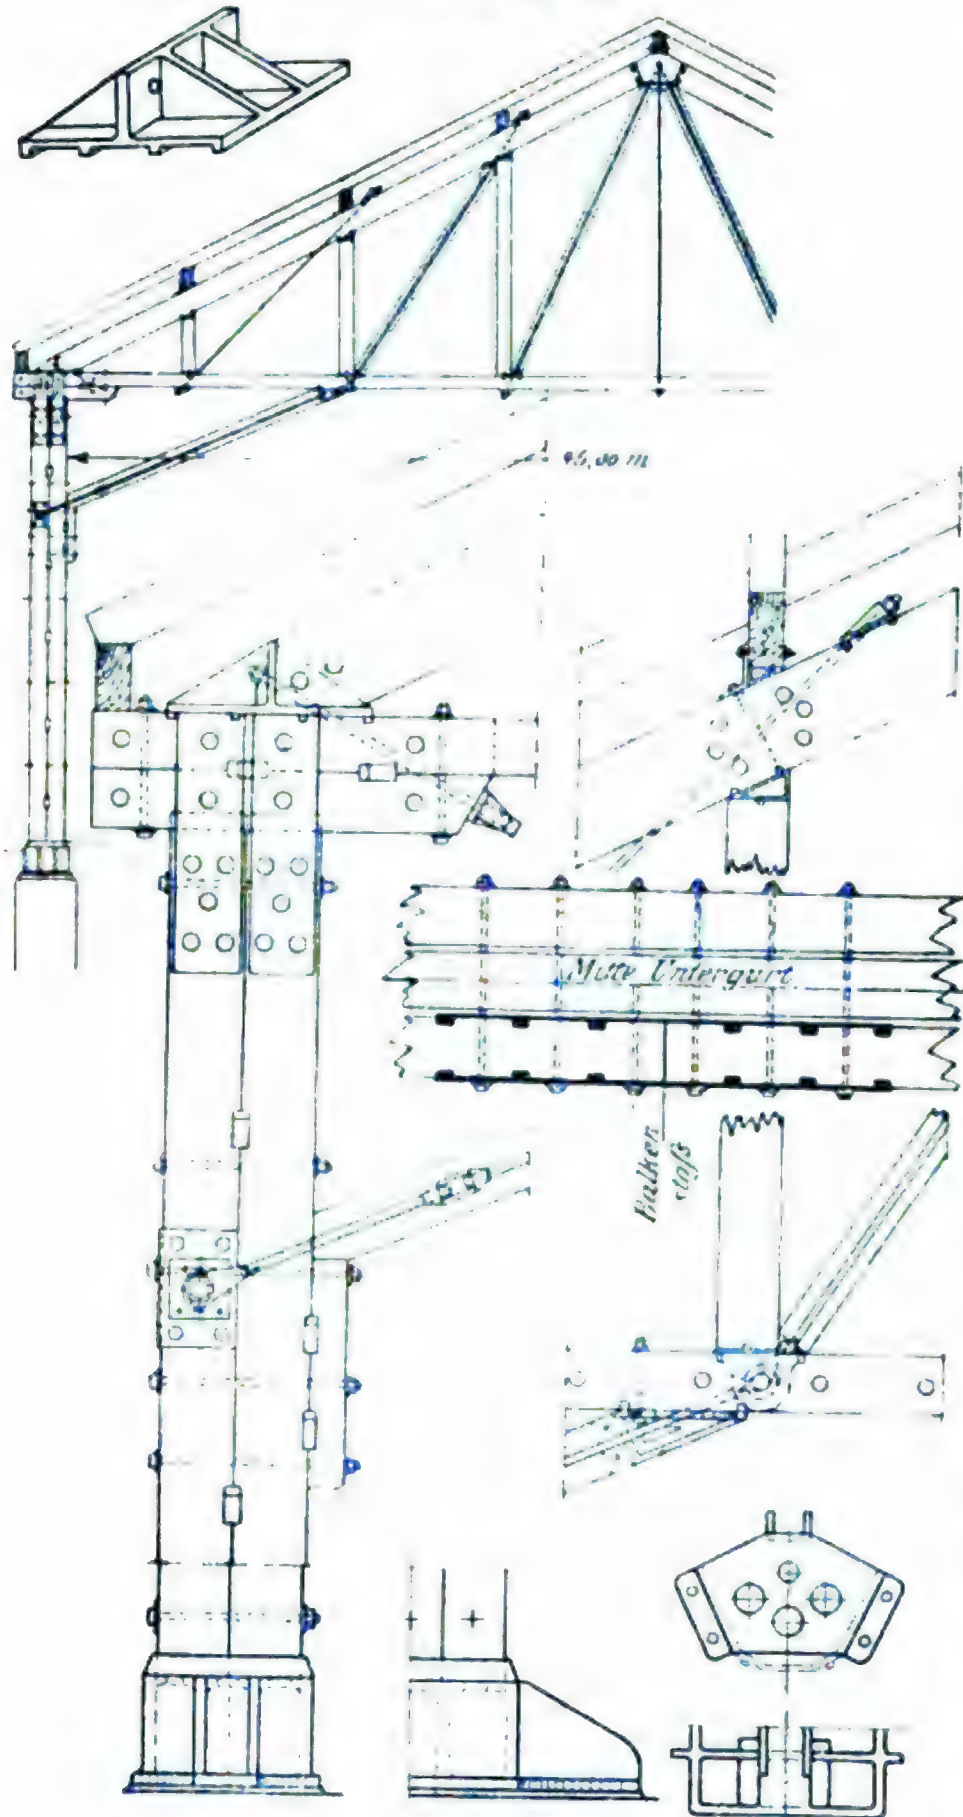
u. 89. Hohes Dach für Kirchen- und Saalbauten. Führung des Untergurtes durch die in den unteren Dachraum eintretende Gewölbedecke bedingt. Pfetten, Obergurte und gedrückte Wandglieder aus Holz, Untergurt und Diagonalen aus Rundeisen. Pfetten bei gröfserer
